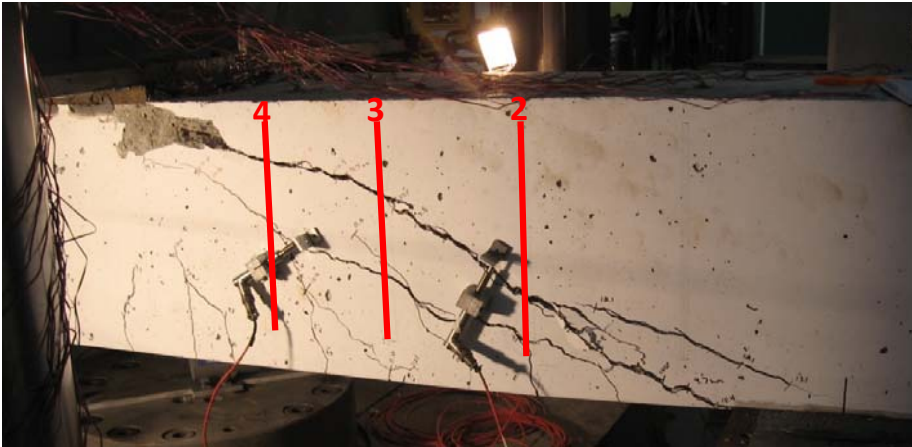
Position des barres de cisailage #2, 3 et 4 de la dalle 1Ba, face nord
